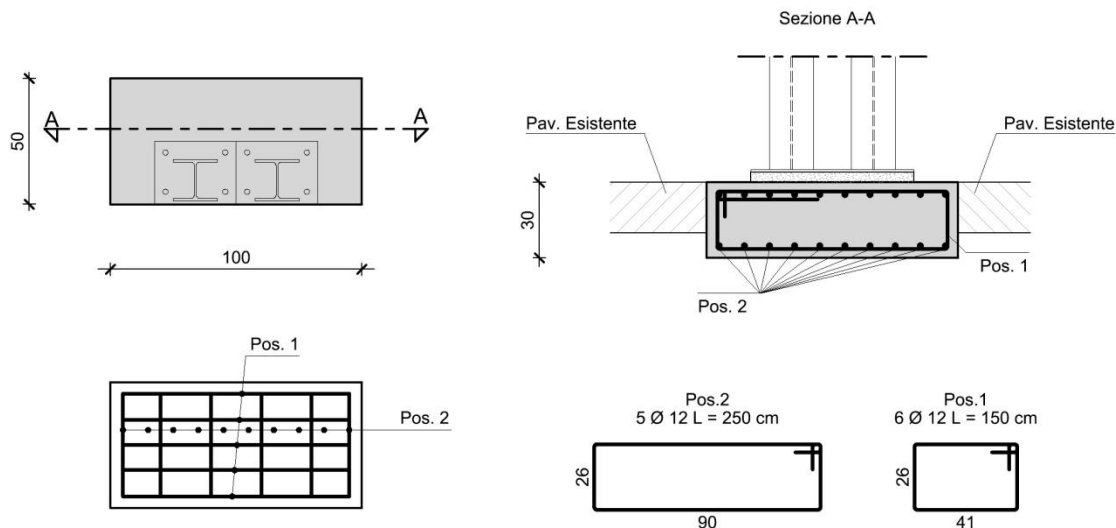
Particolare di A.2014.a.il.T01 - Telaio di sostegno scala cabina elettrica - Plinti di fondazione
